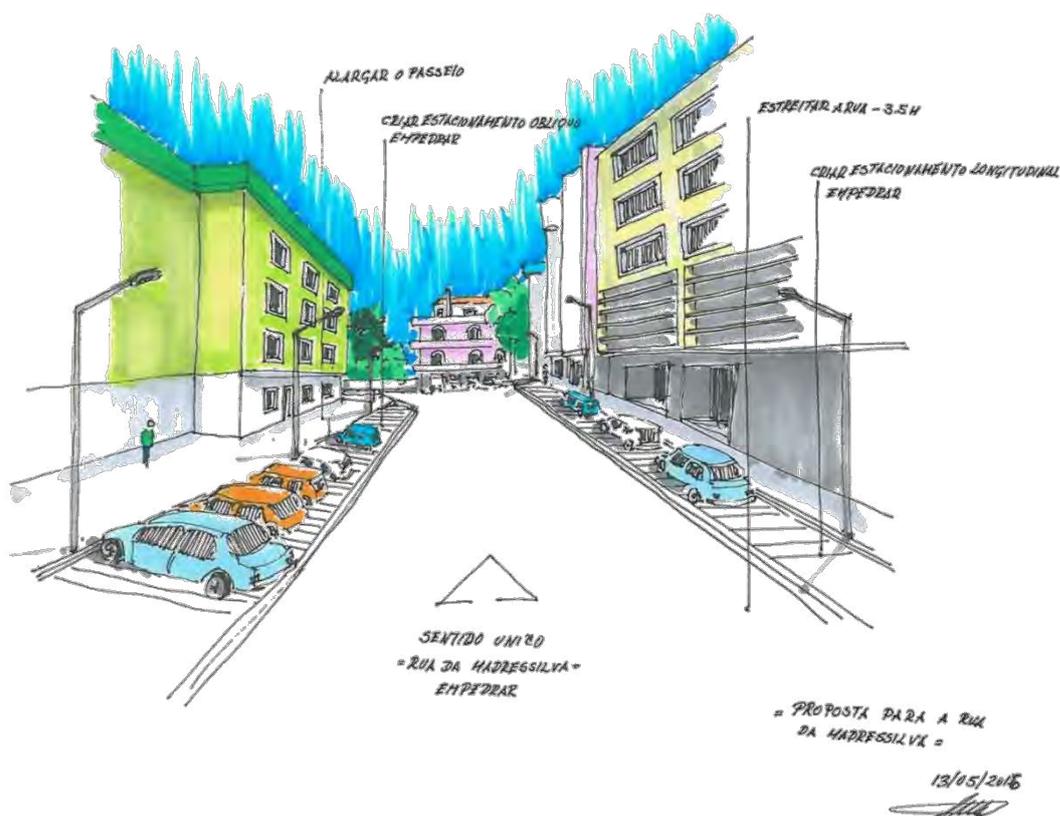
Proposta de Intenção de reorganização do perfil da Rua da Madressilva
